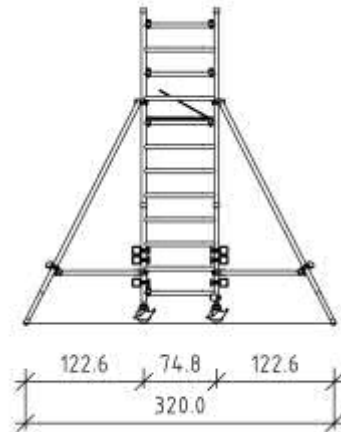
Aufbau mit Alu-Gerüststütze, Standhöhe 2.25 m
